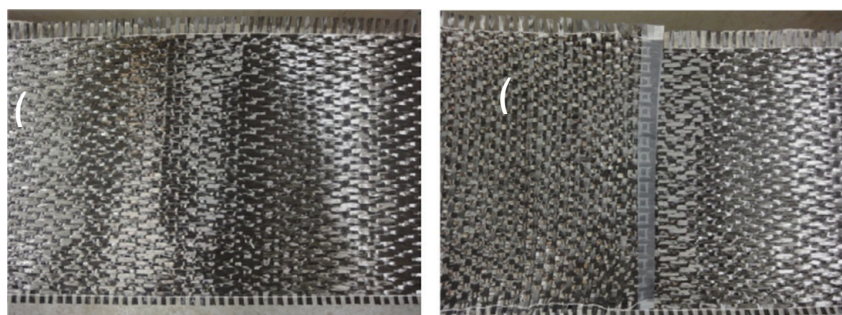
Tissu de renforcement – (a) Face extérieure et (b) Face coté poutre
